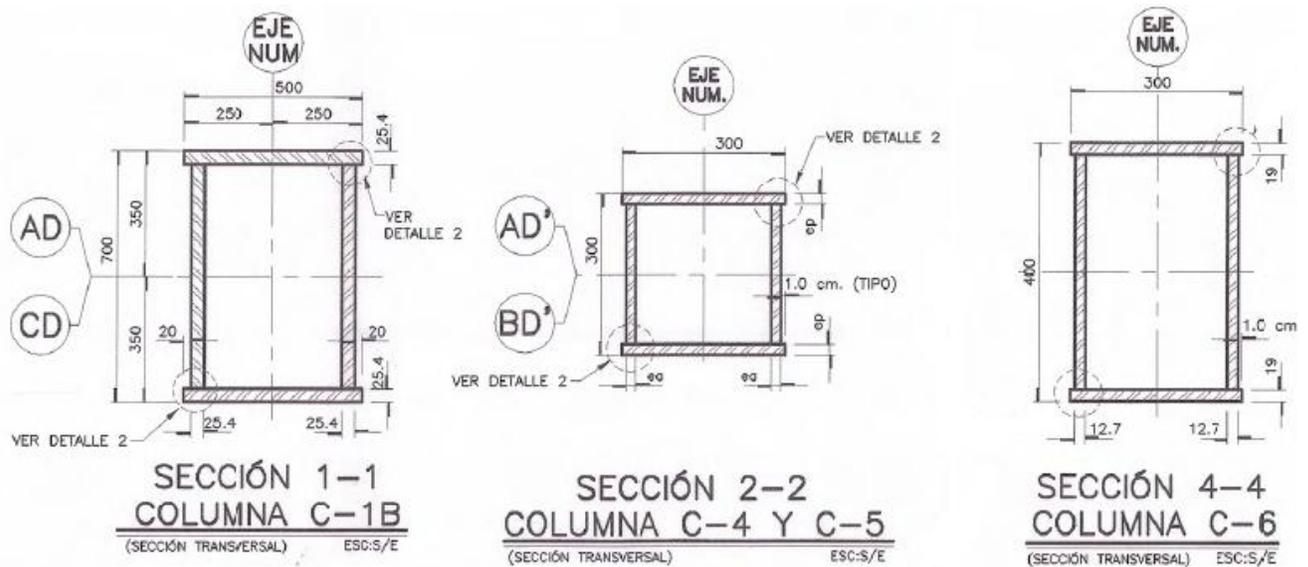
Sección de columnas tipo cajón principales C-1B y c-6, secundarias c-4 y c-5.
